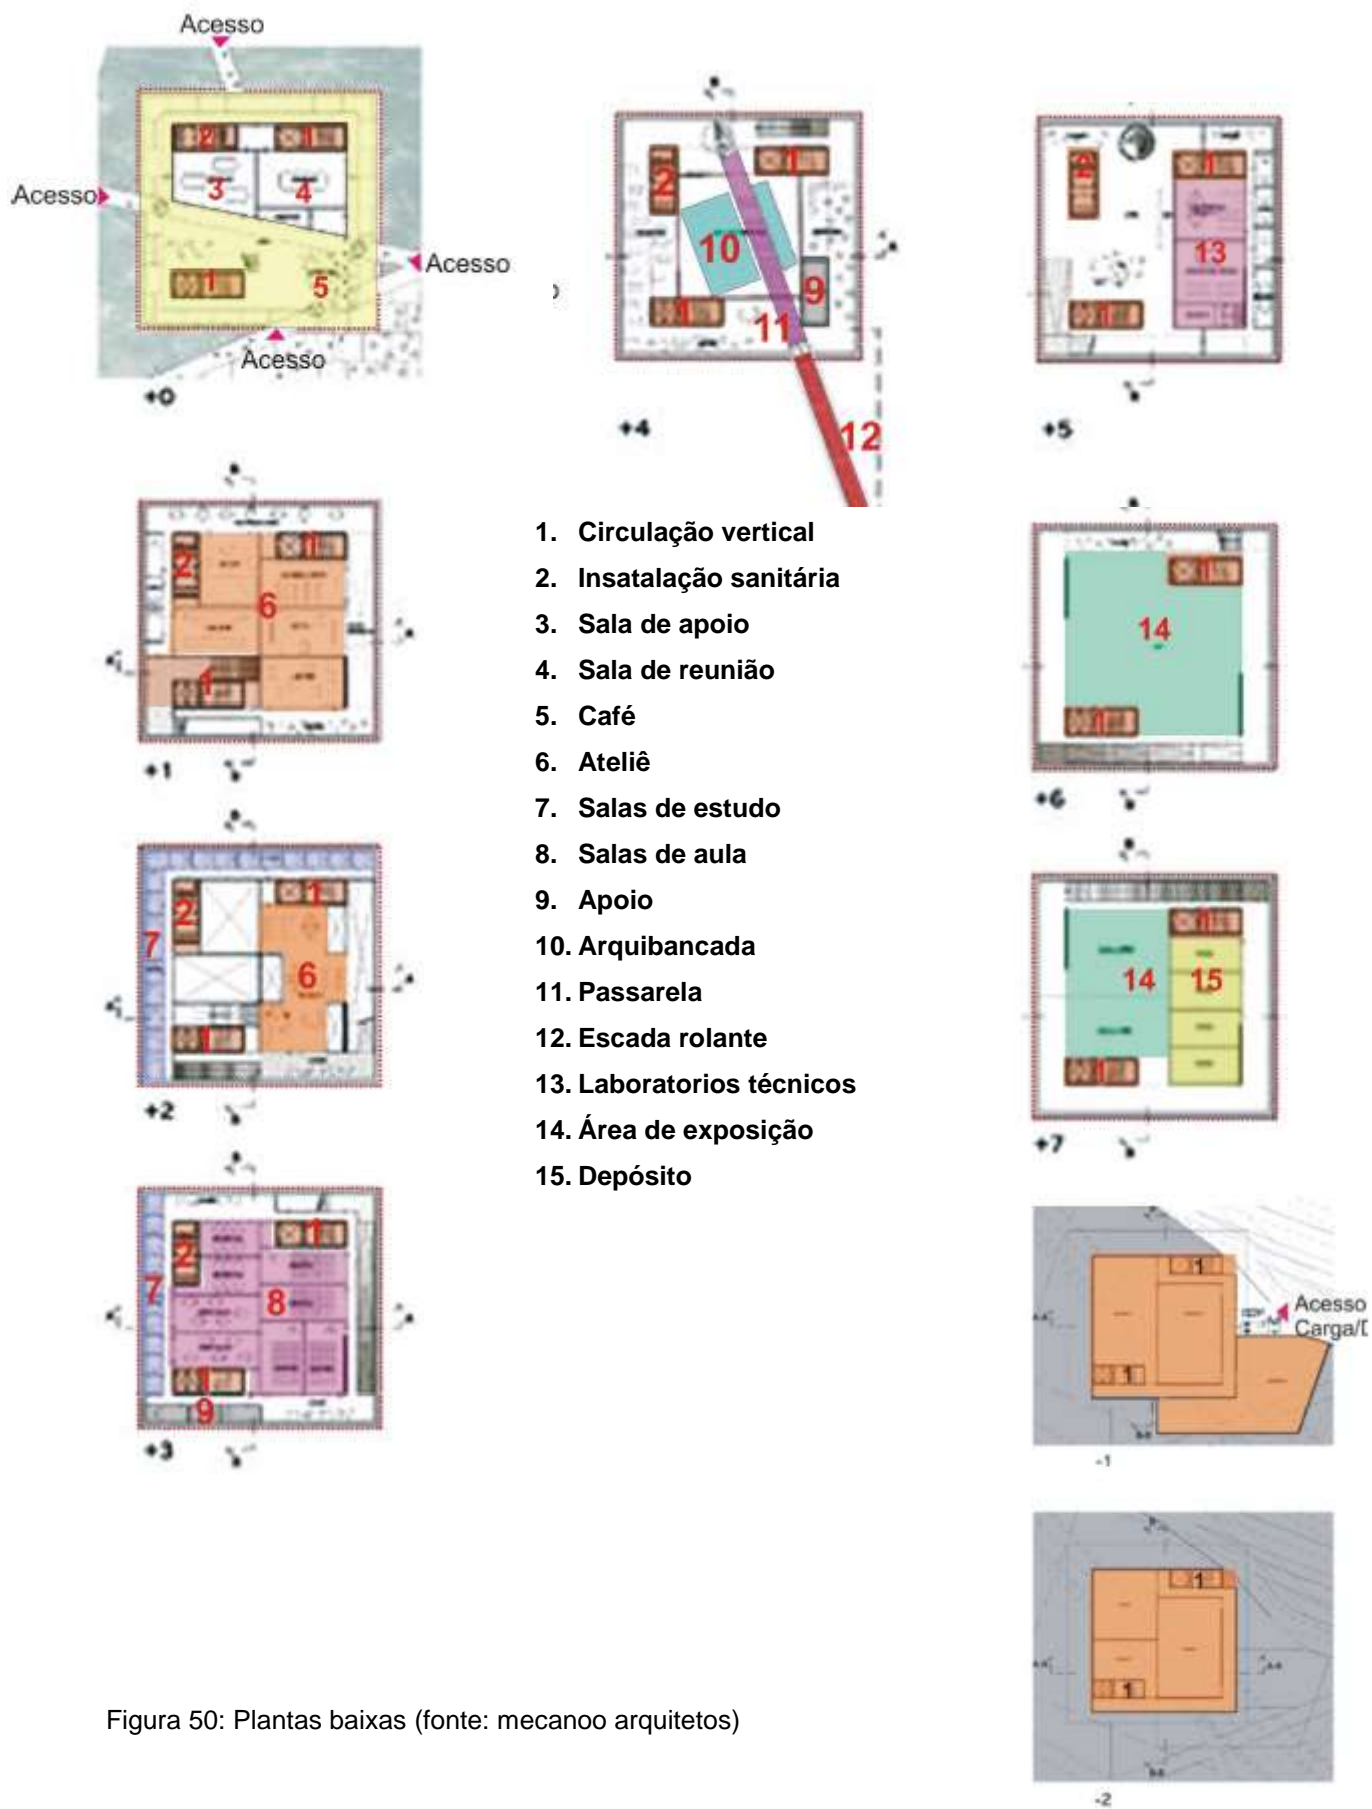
Plantas baixas (fonte: mecanoo arquitetos)
